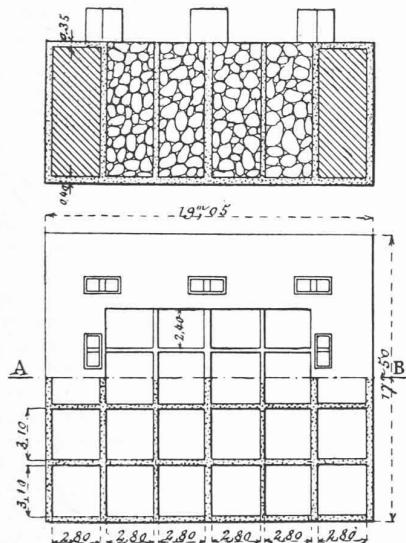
et 2. — Plan-coupe horizontale et coupe verticale d'un caisson.
